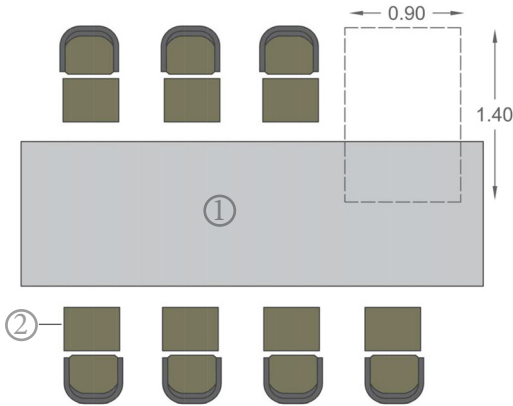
1 Espacio PSdR en mesa - Planta
